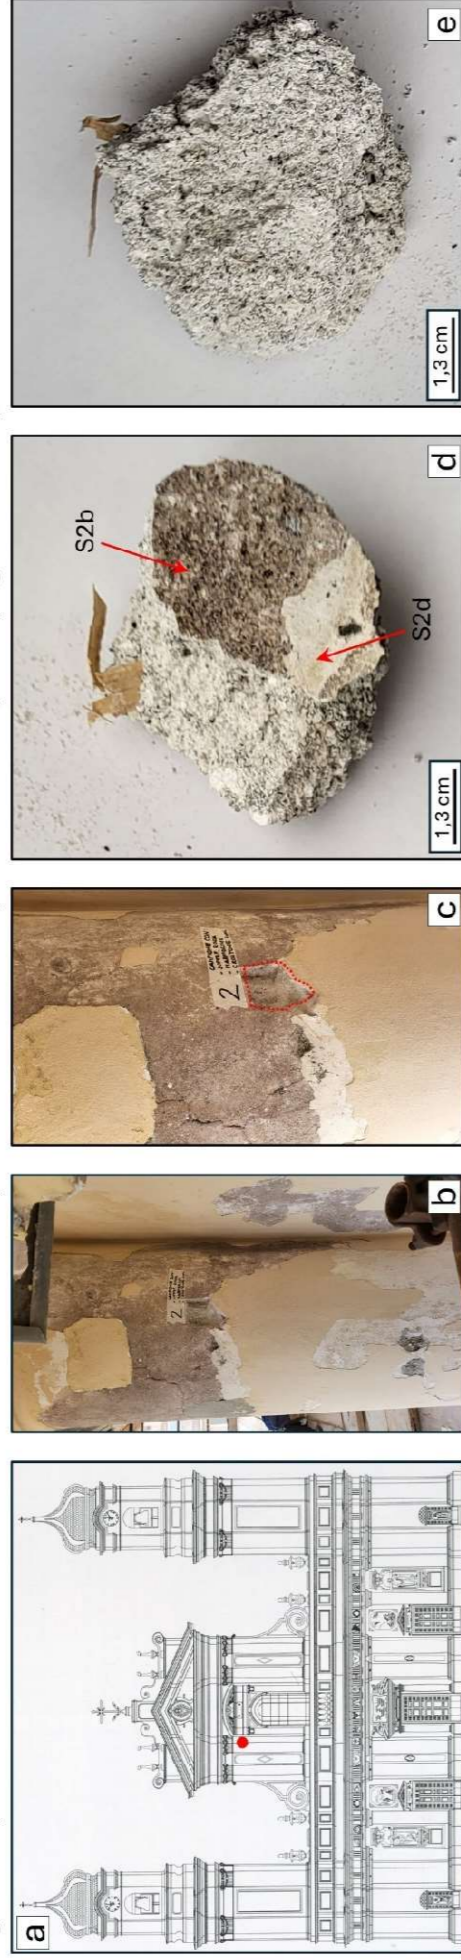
a) posizione campione nel prospetto principale della Basilica; b) punto di prelievo del campione nella colonna; c) particolare del punto di prelievo del campione (tratteggio rosso); d) campione C2B (vista dall'alto); e) campione C2B (vista dal basso).
